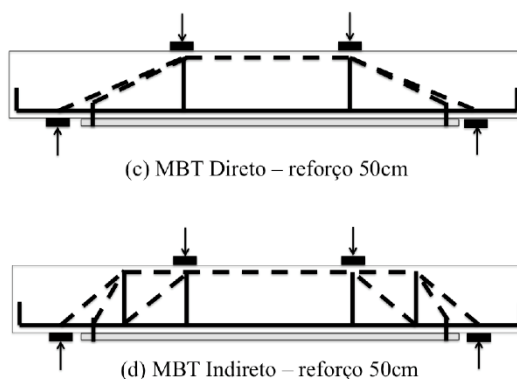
Modelo bielas e tirantes direto e indireto para vigas reforçadas com chapas de aço de 50cm coladas e aparafusadas (viga X3)
